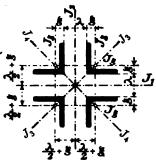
Aus vier ungleichschenkeligen Winkeleisen bestehender Ouerschnitt. Abb. 63.
